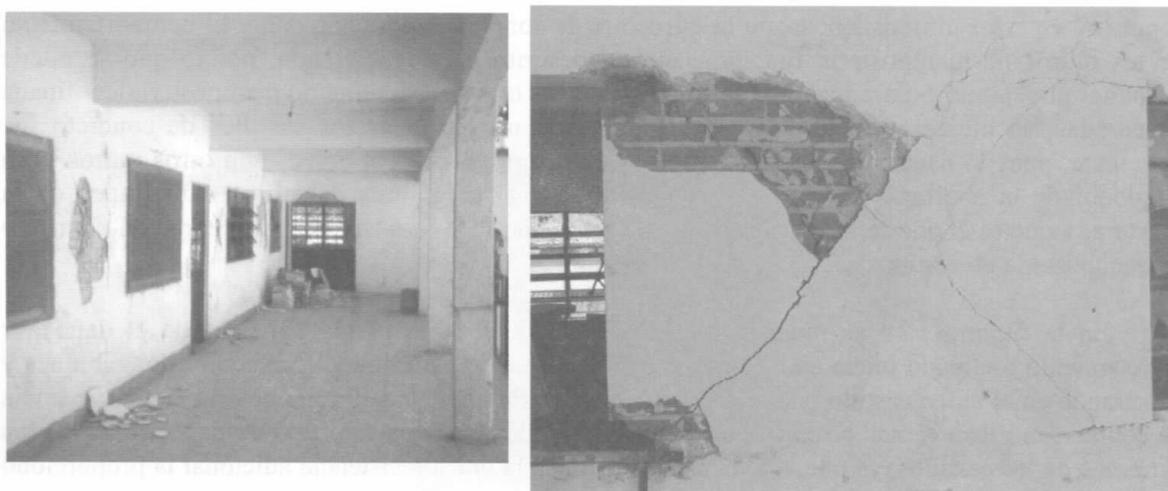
Agrietamiento en X en segmentos de muro en la planta alta
